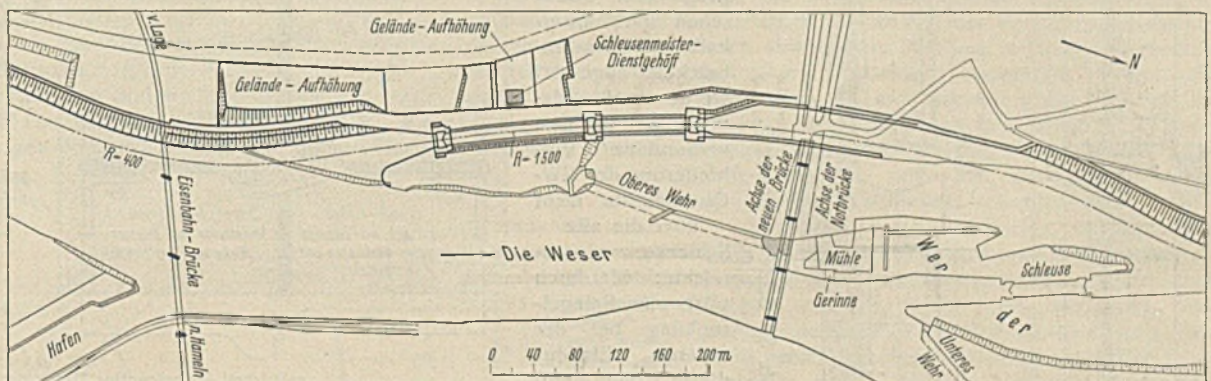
Lageplan der Schleppzugschleuse Hameln.
